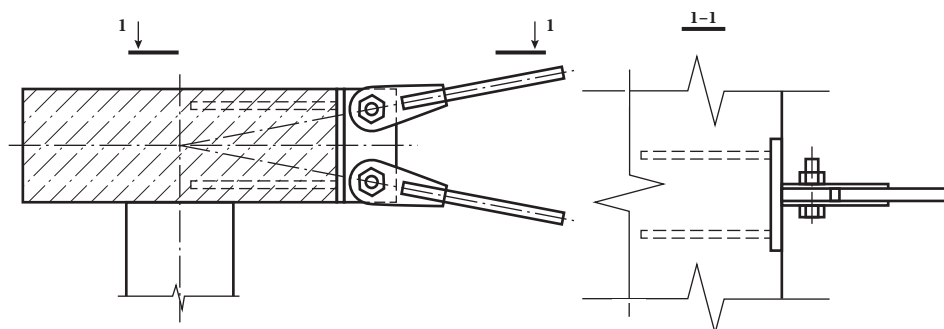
Варианты крепления вант к железобетонному опорному контуру в двухпоясных покрытиях
